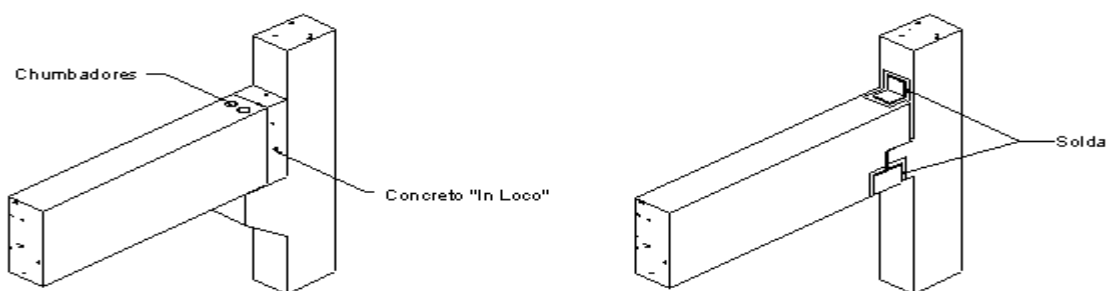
Ligação viga-pilar rígida feita com solda ou com concreto moldado in loco.
